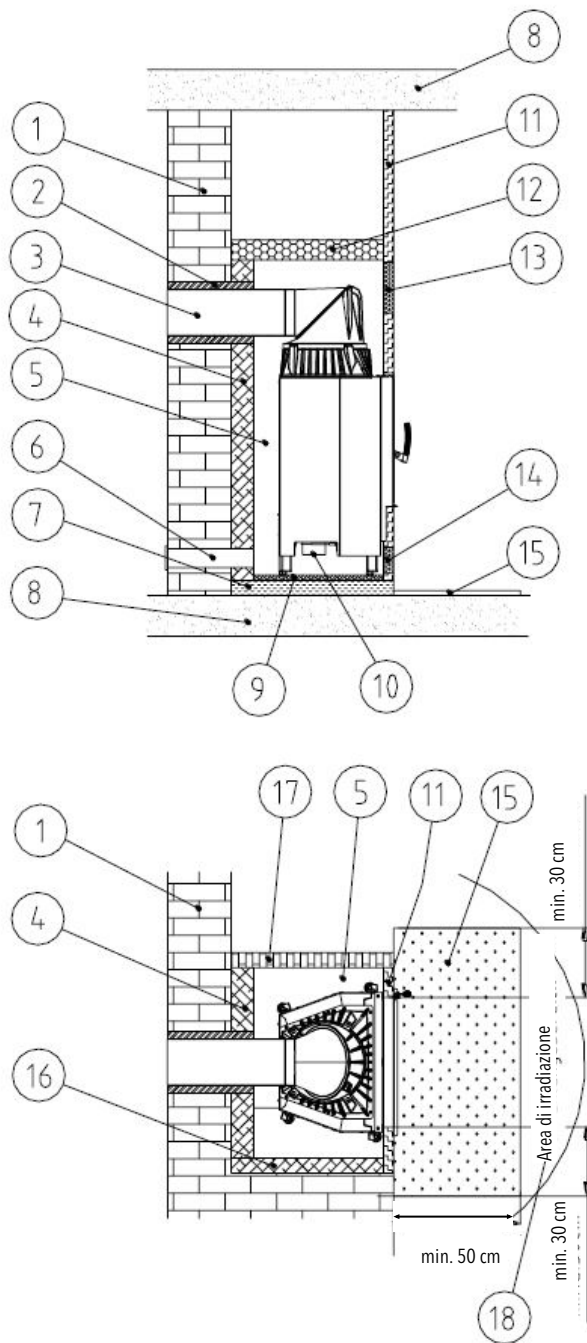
Montaggio davanti/accanto a una parete da proteggere
